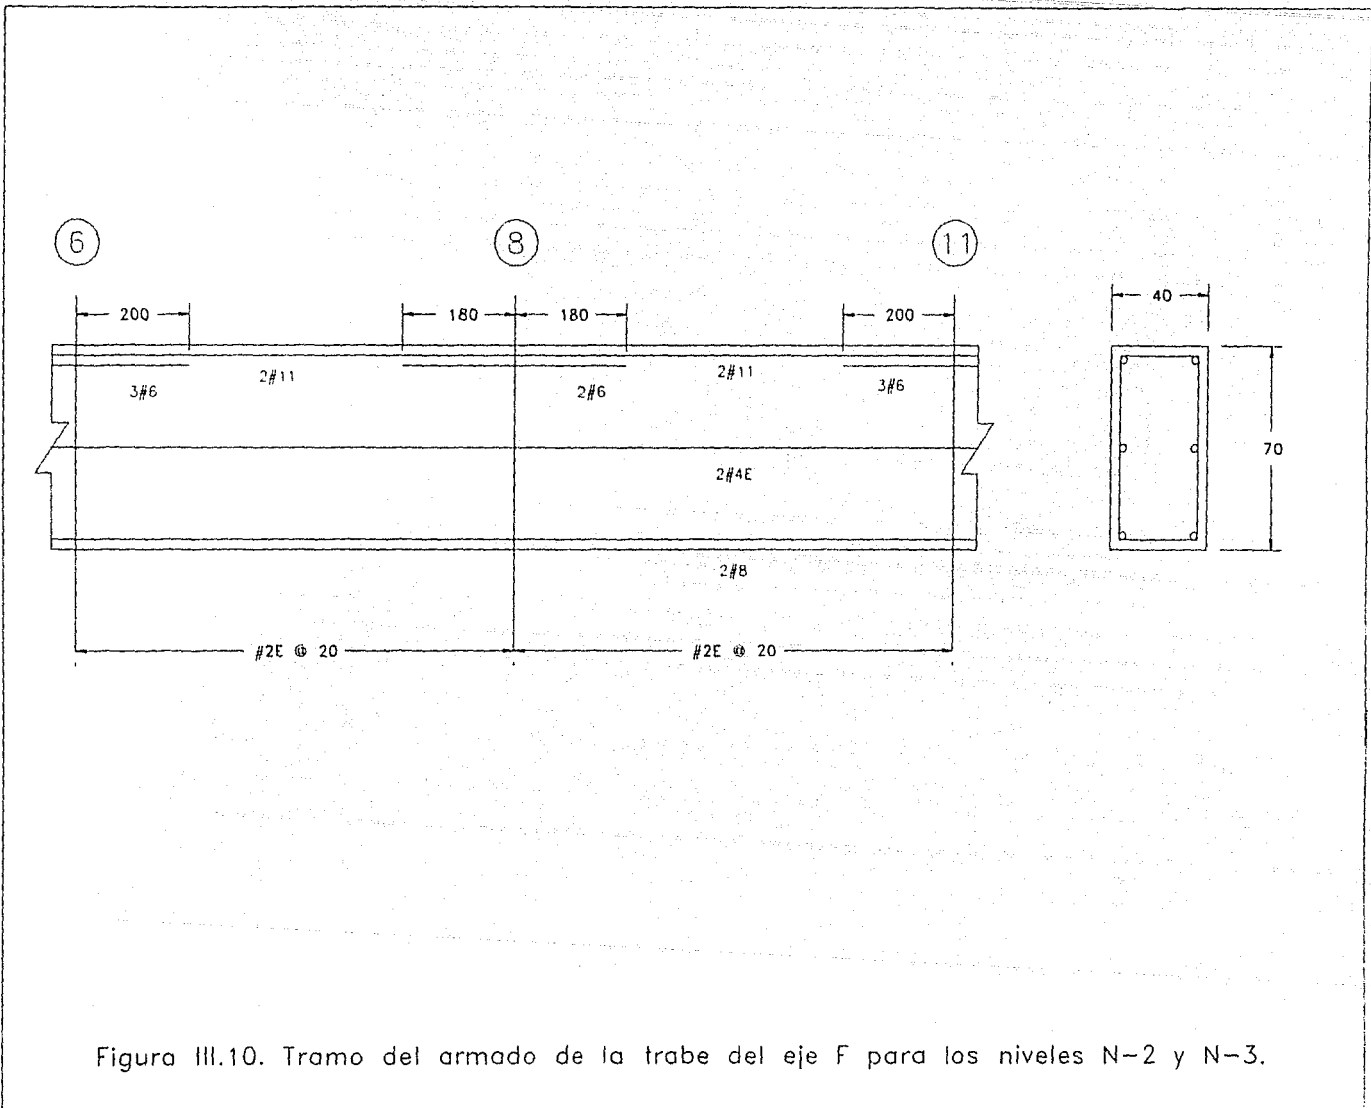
Tramo del armado de la trabe del eje F para los niveles N-2 y N-3.
